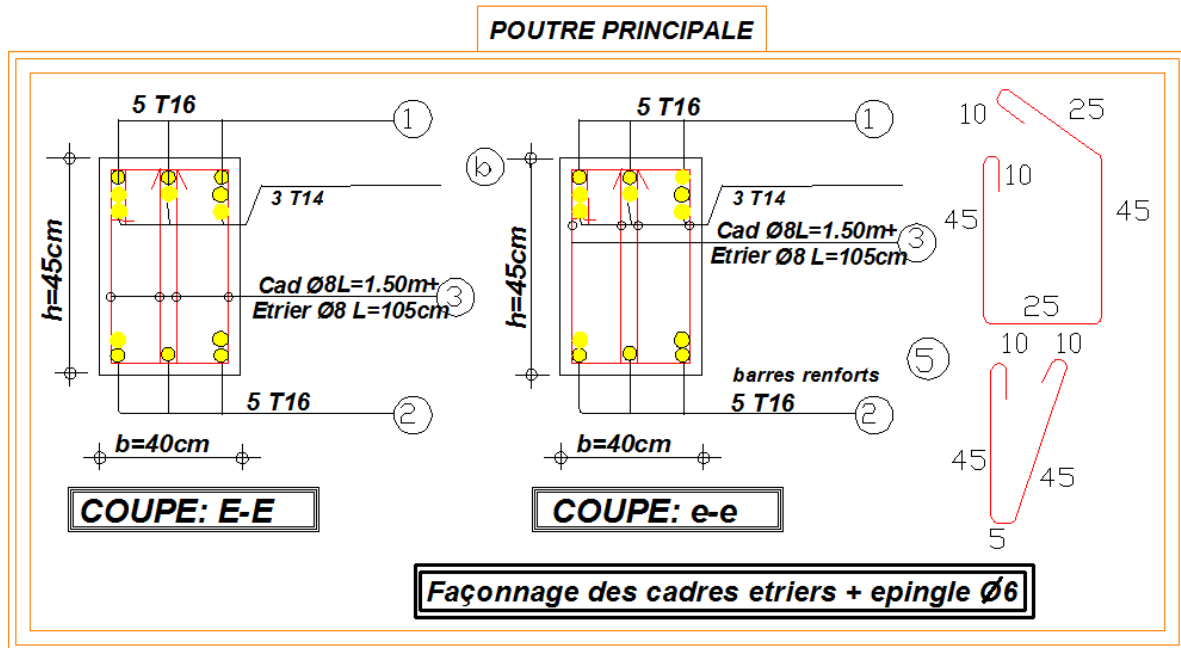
ferrailage des poutres principales de 8ème10 ème étage
